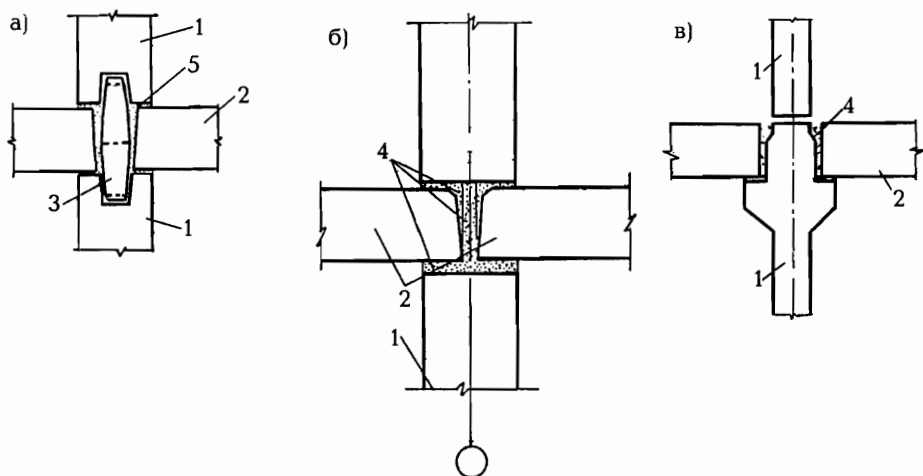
Стыки панелей внутренних несущих стен и перекрытий: а, б - платформенные; в - контактный, 1 - стеновая панель; 2 - панели перекрытия; 3 - фиксатор; 4 - цементно-песчаный раствор
